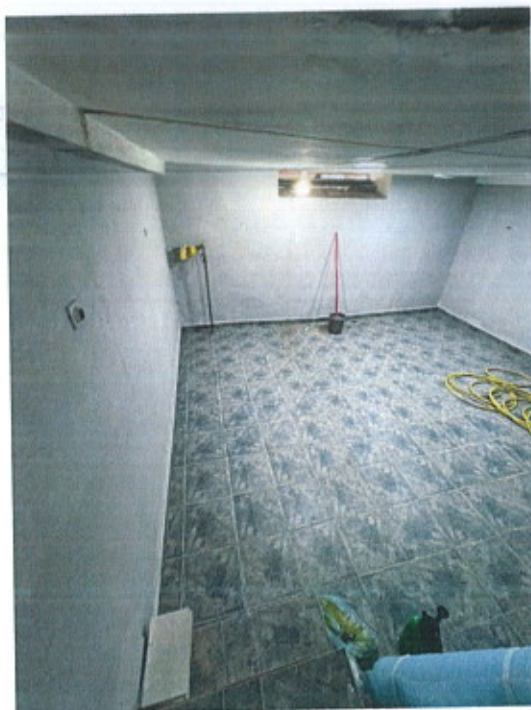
Foto e hapësirës së bodrumit, mars 2023
